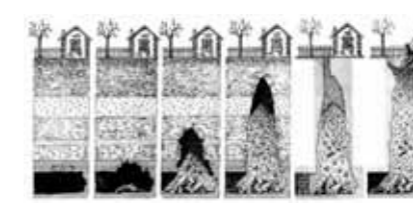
Dutina pod betonovým základem (zdroj: internet)
